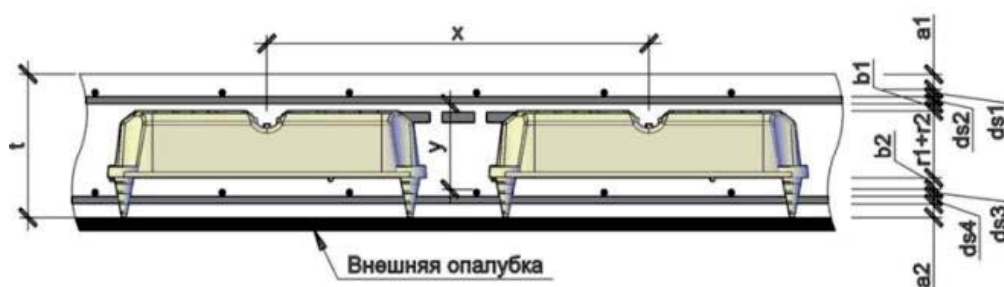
Схема размещения одиночных пустотообразователей и армирования плиты перекрытия
